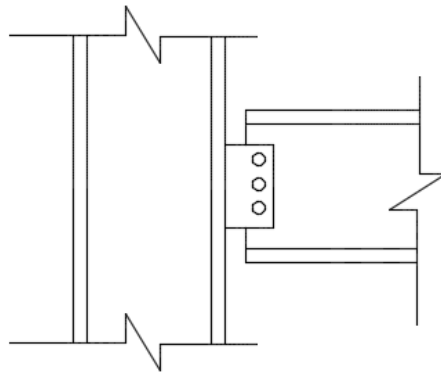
Conexión de cortante tipo Placa Paralela de viga a columna.
